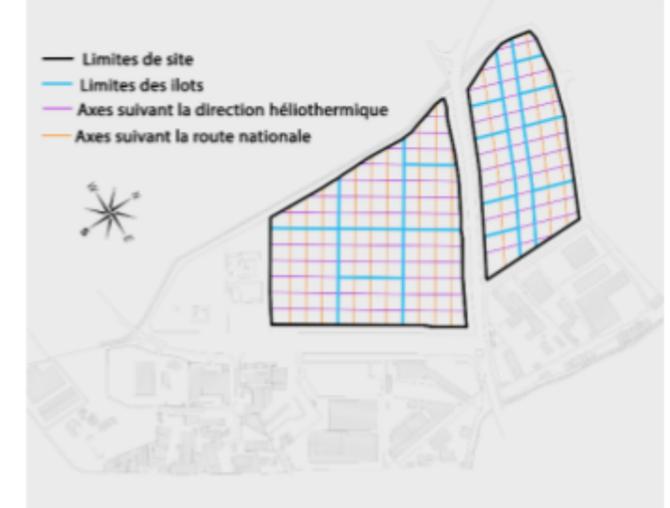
la segmentation du terrain suivant la trame. Source : Travail d'auteur
